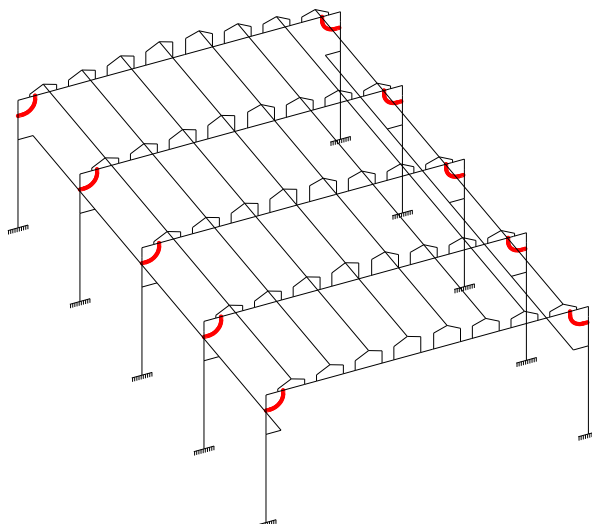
Esempio di modellazione di un edificio prefabbricato industriale con dispositivi di connessione trave-pilastro.
